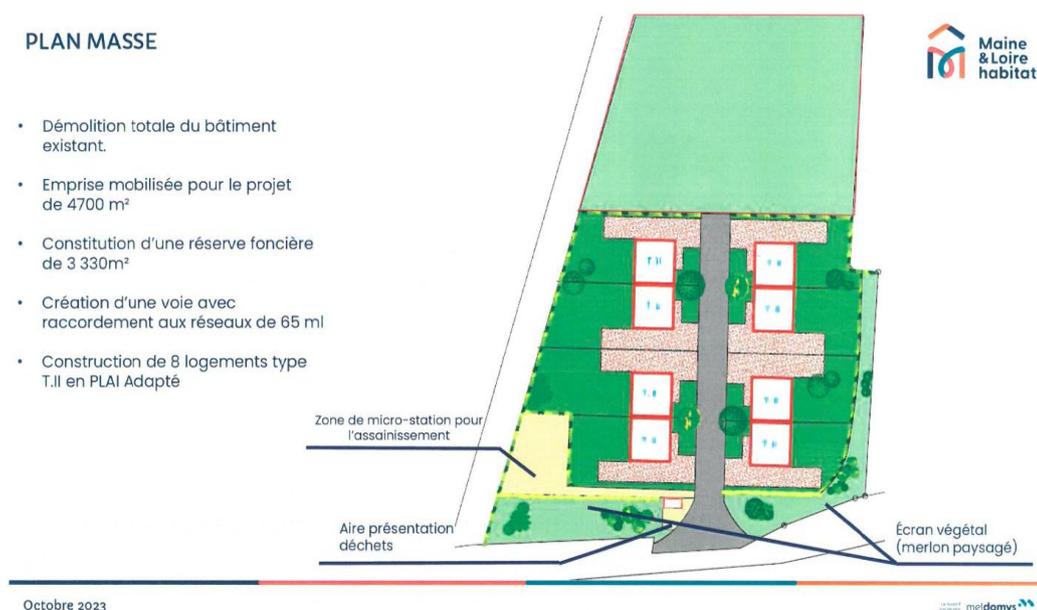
PLAN DE MASSE DES FUTURS TRAVAUX
